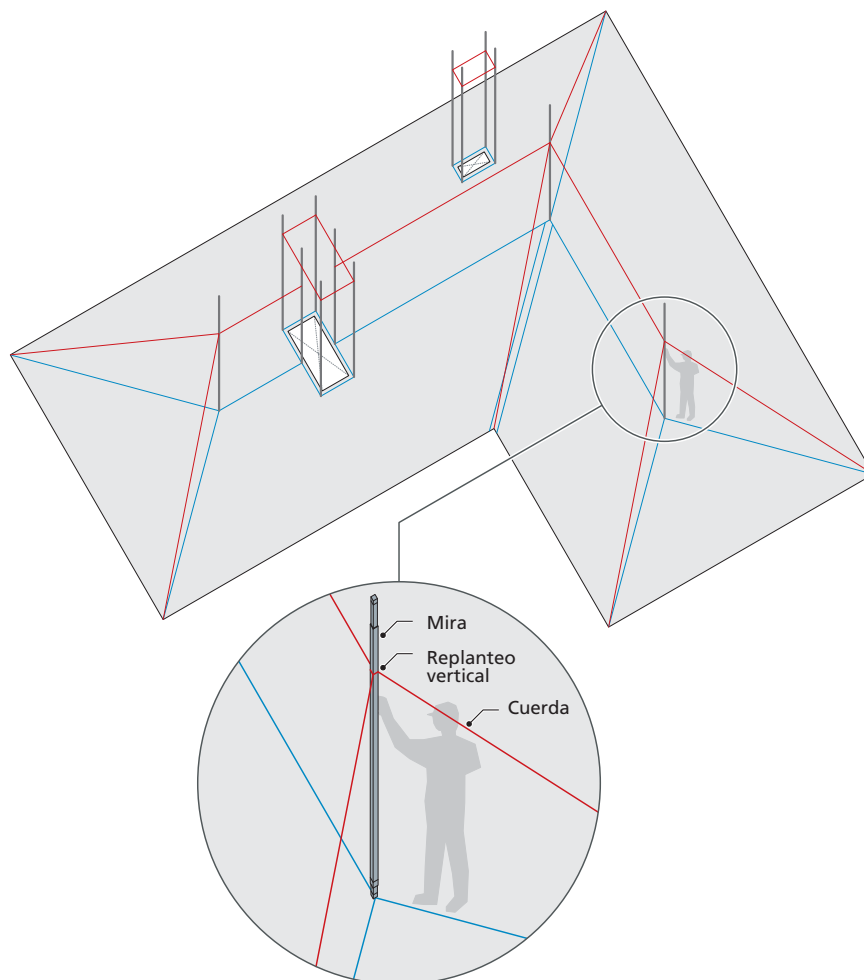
Replanteo de tabiques palomeros paralelos al alero en cubierta inclinada sobre forjado en el caso de que las viguetas del forjado sean perpendiculares al muro exterior
